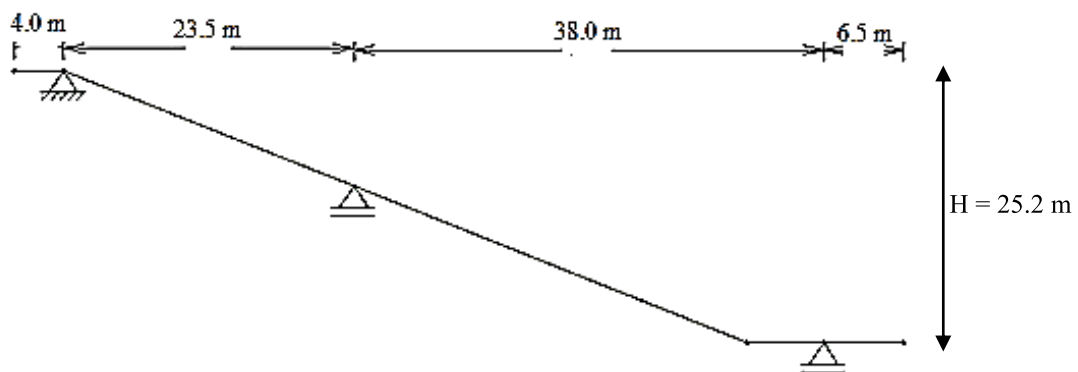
Modelo de Pré-dimensionamento para as Vigas Verticais
